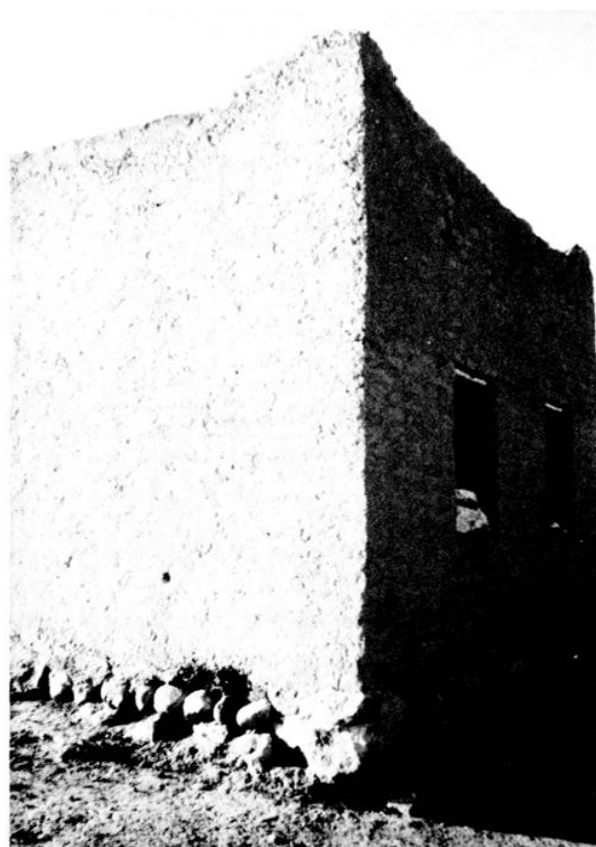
Pierre angulaire (Mureybet, Syrie).
